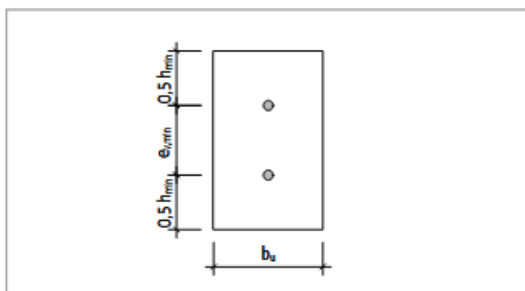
Schöck Stacon® Typ LD: Minimale Bauteilabmessungen und Dornabstände an der Stirnseite eines Balkens oder einer Wand
